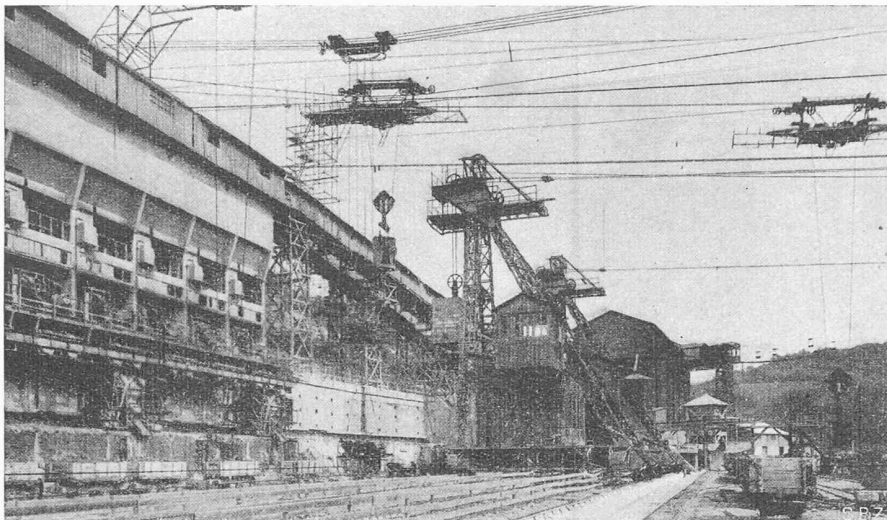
Betonfabrik und Kabelkrane für den Mauerbau (in Bild 1 nicht angegeben)
